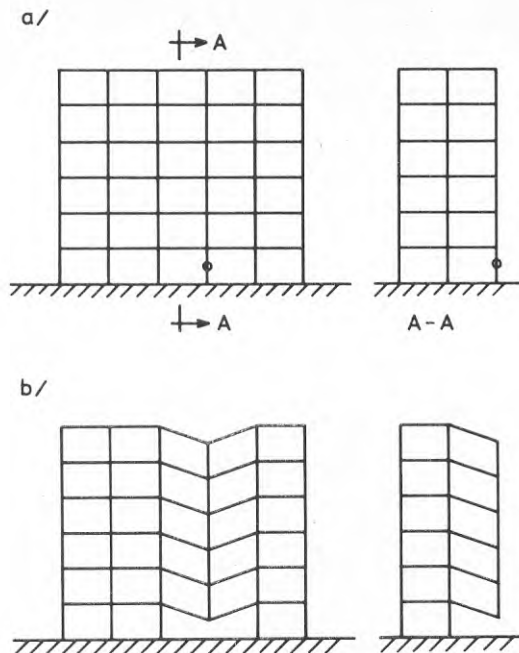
Ursprungligt (a) och alternativt (b) bärande system [7].
